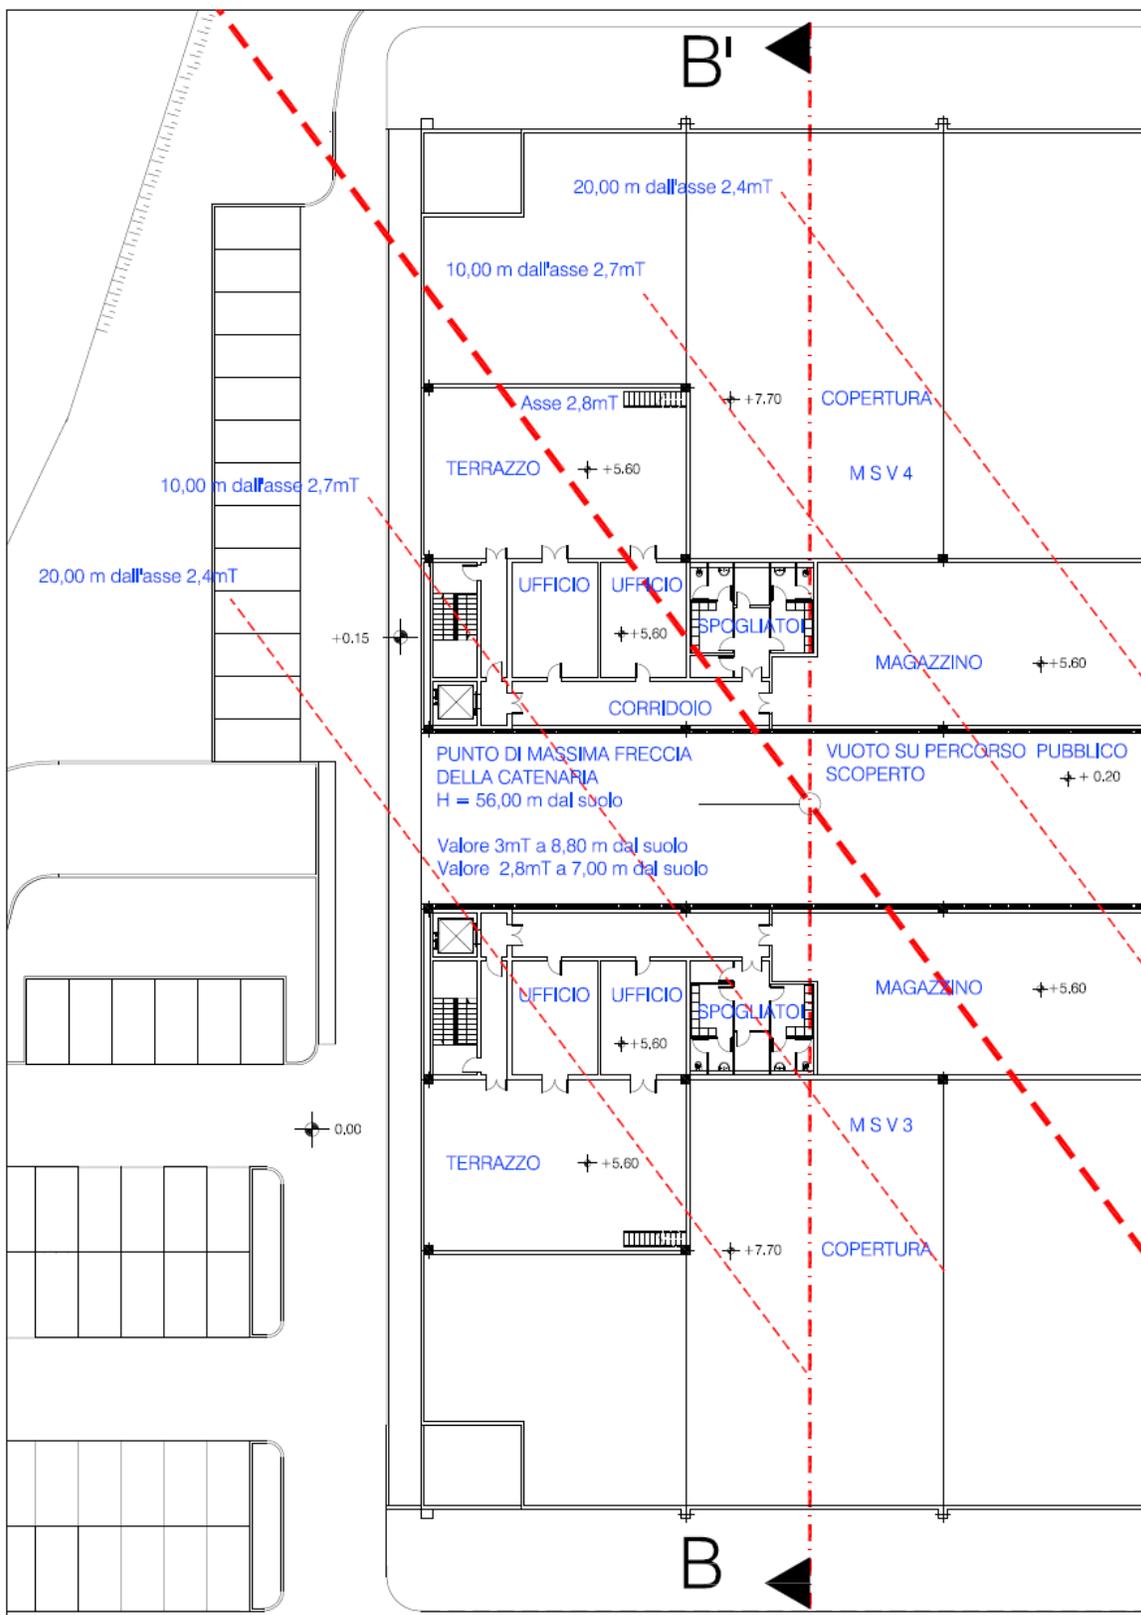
Parco commerciale, planimetria piano primo (stralcio).
